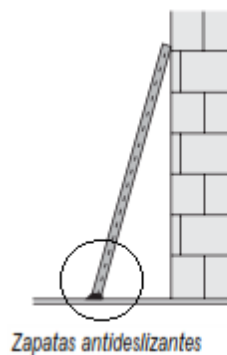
Zapatillas antideslizantes en escalera. Fuente: Nota Técnica trabajos en alturas, protección.
